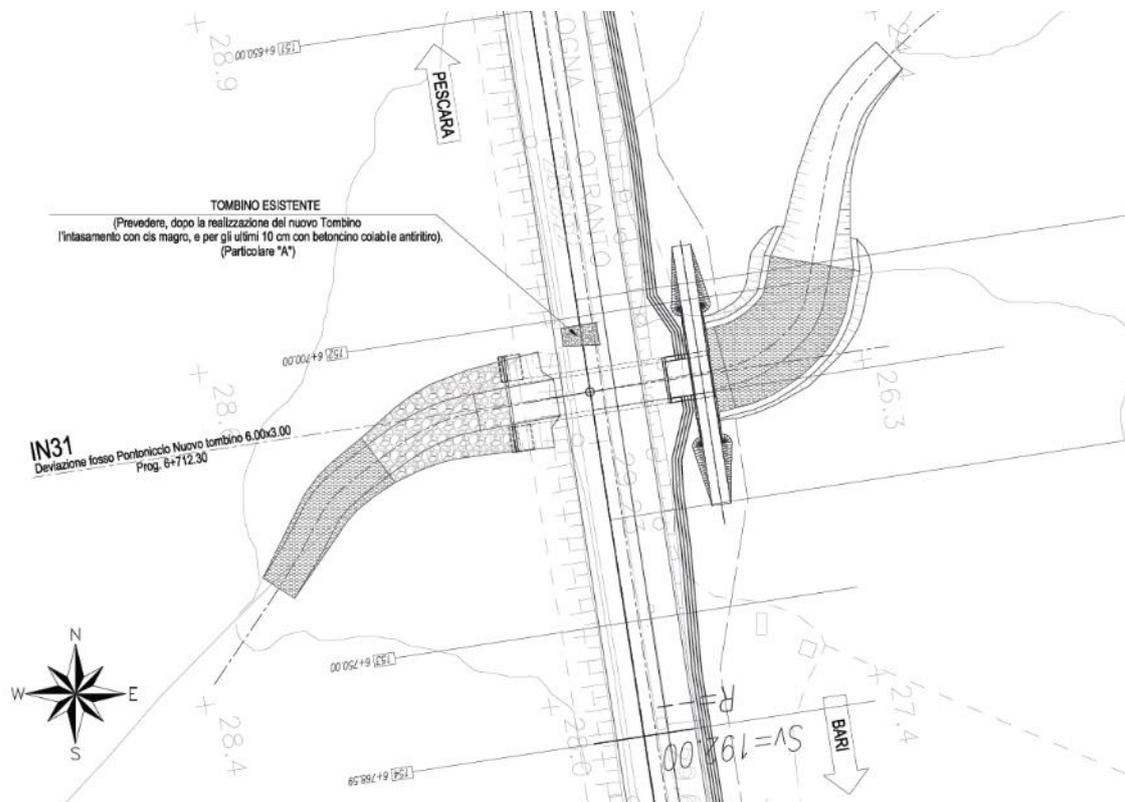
Adeguamento idraulico Fosso Pontonicchio – Vista Planimetrica
